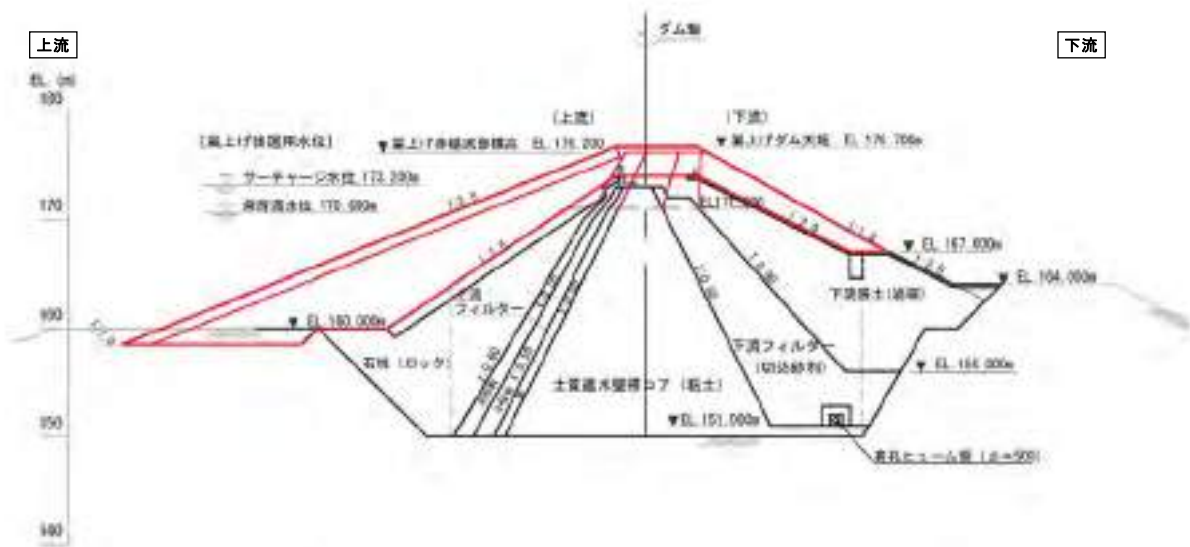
ダム堤体の標準断面図（右岸フィルダム部）
